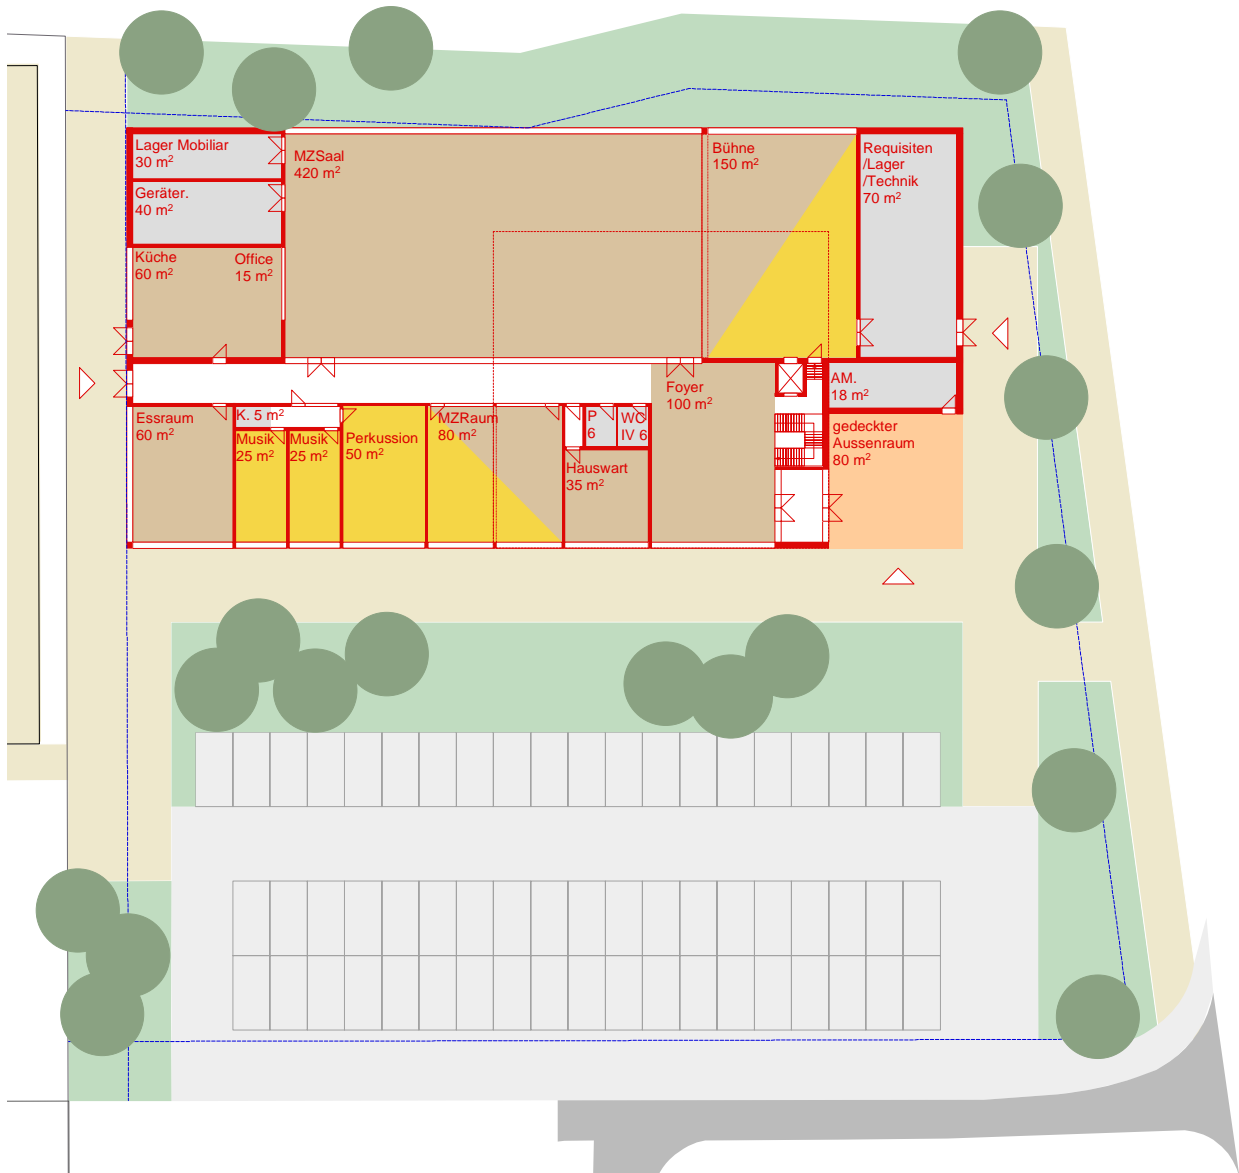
Schemaplan Mehrzweckgebäude, Erdgeschoss und Untergeschoss
